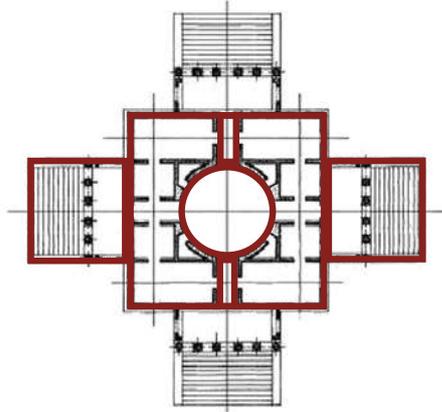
Andrea Palladio. Planta Villa Rotonda.1566.
